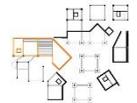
Axonometría Estructural - Techo Planta Primera - Alzado Sur
